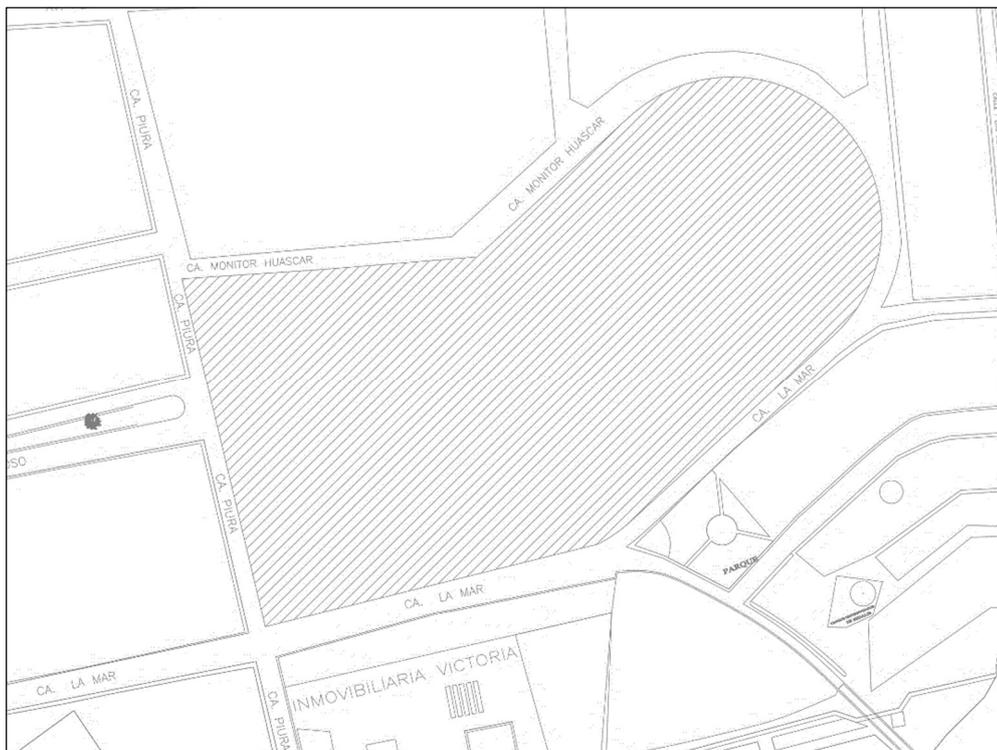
ubicación del terreno - plano. Elaboración: Propia
